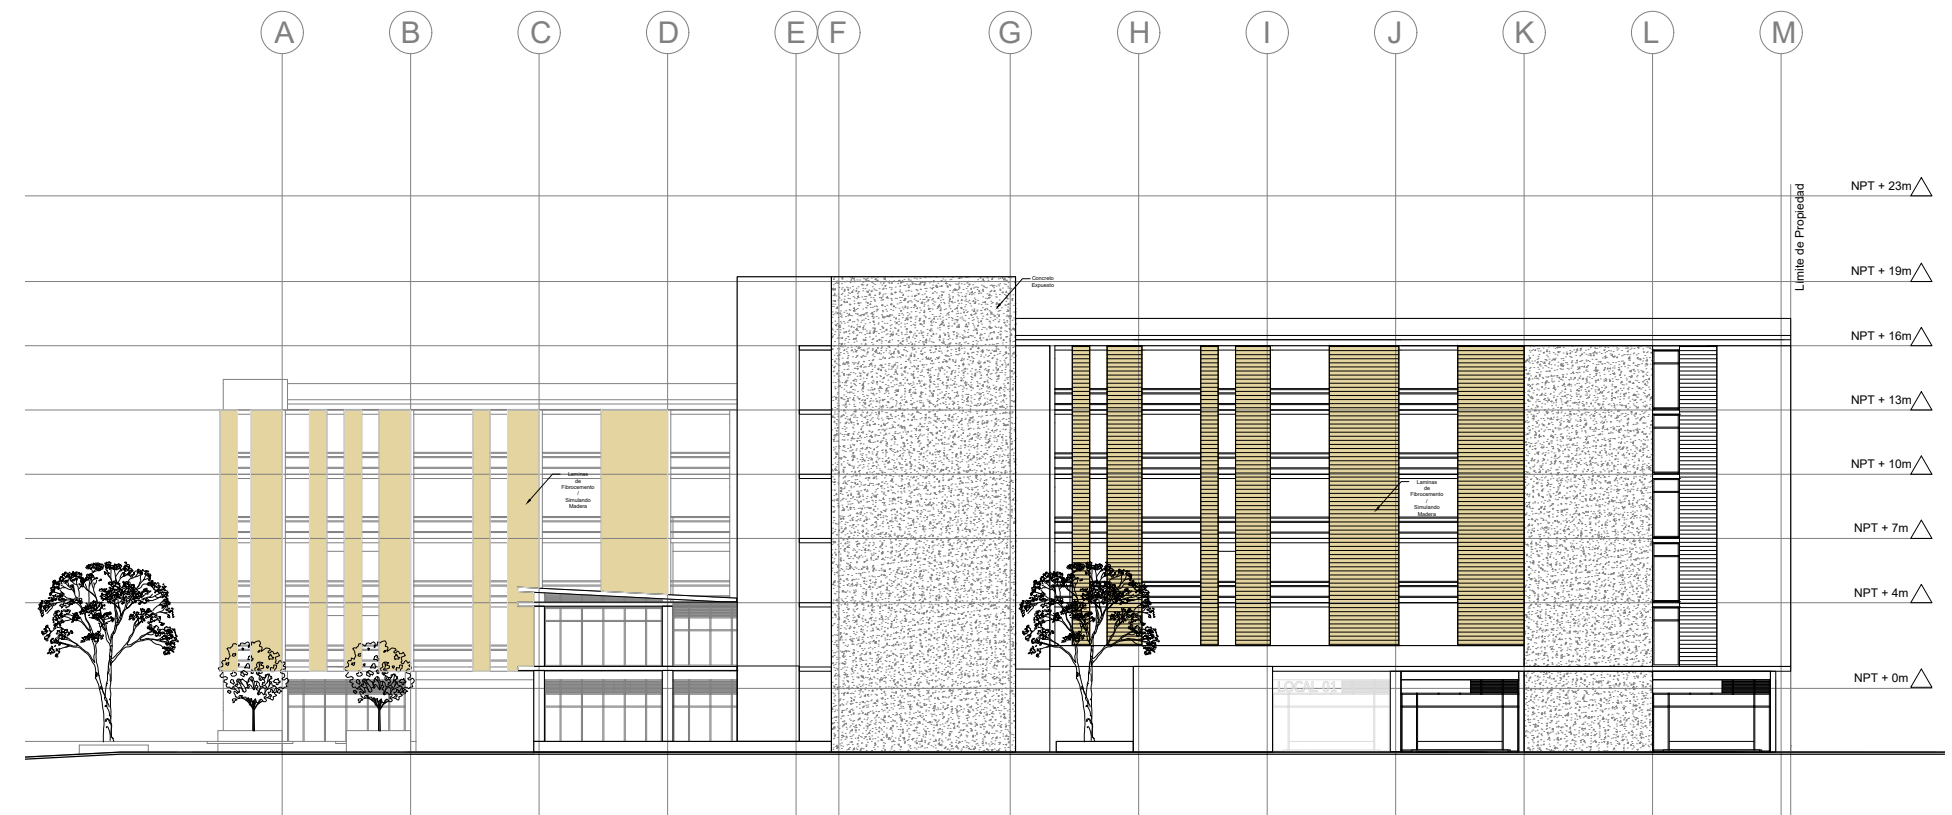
Fachada sur. Fuente: Elaboración propia.
